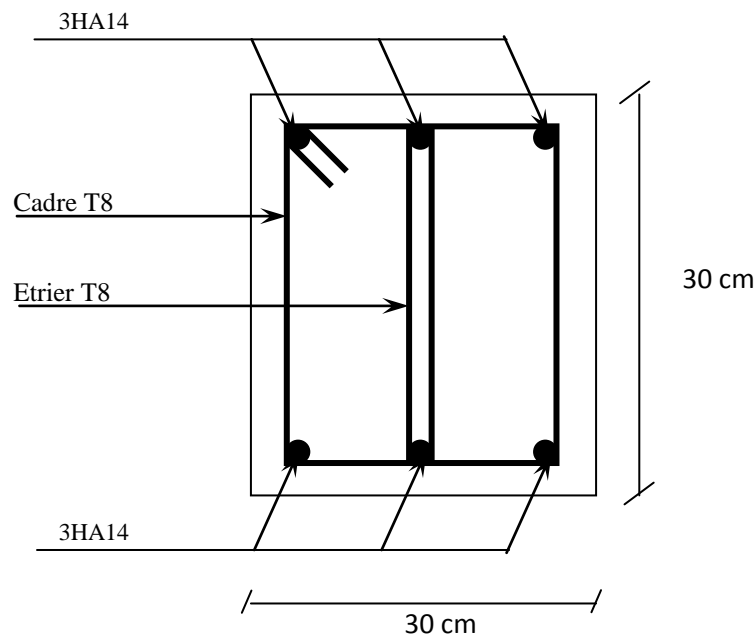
Schéma de ferrailage de la poutre palière.
